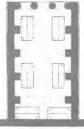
Maufoleum in Kerbet-Häss. Grundriss.
